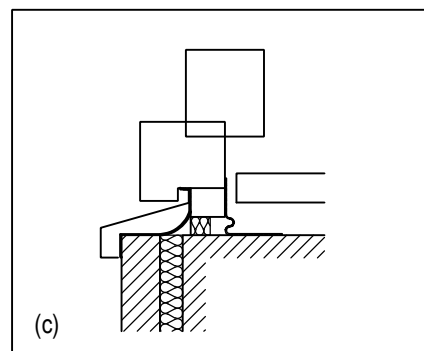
В 4: (c) Зовнішнє ущільнення для двошарової кладки з ізоляцією (c)
